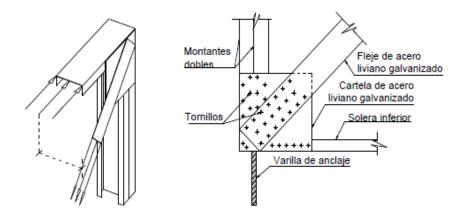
Detalle de anclajes de Fleje. Fuente: (ConsulSteel, 2014).
